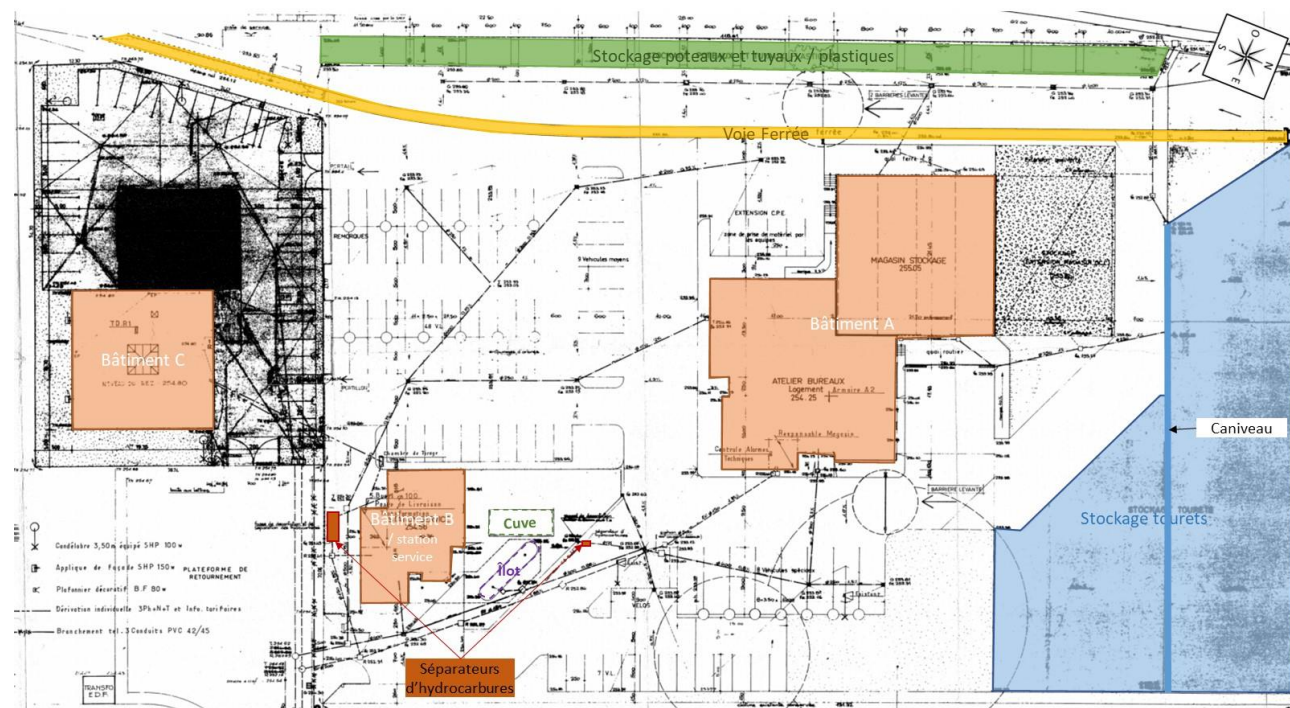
PLAN DE MASSE DE L'ENSEMBLE DU SITE – PLAN EN DATE D'AOUT 1988
